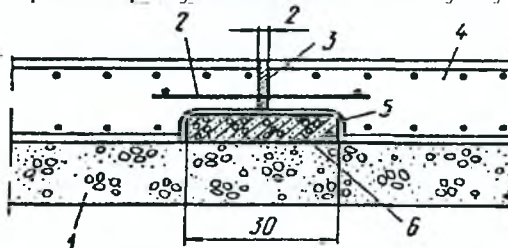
Конструктивный шов между монолитными железобетонными плитами: 1 – щебеночная или гравийная подготовка; 2 – арматурный каркас шва; 3 – доска, пропитанная креозотом; 4 – плита; 5 – битумный мат; 6 – железобетонная доска
